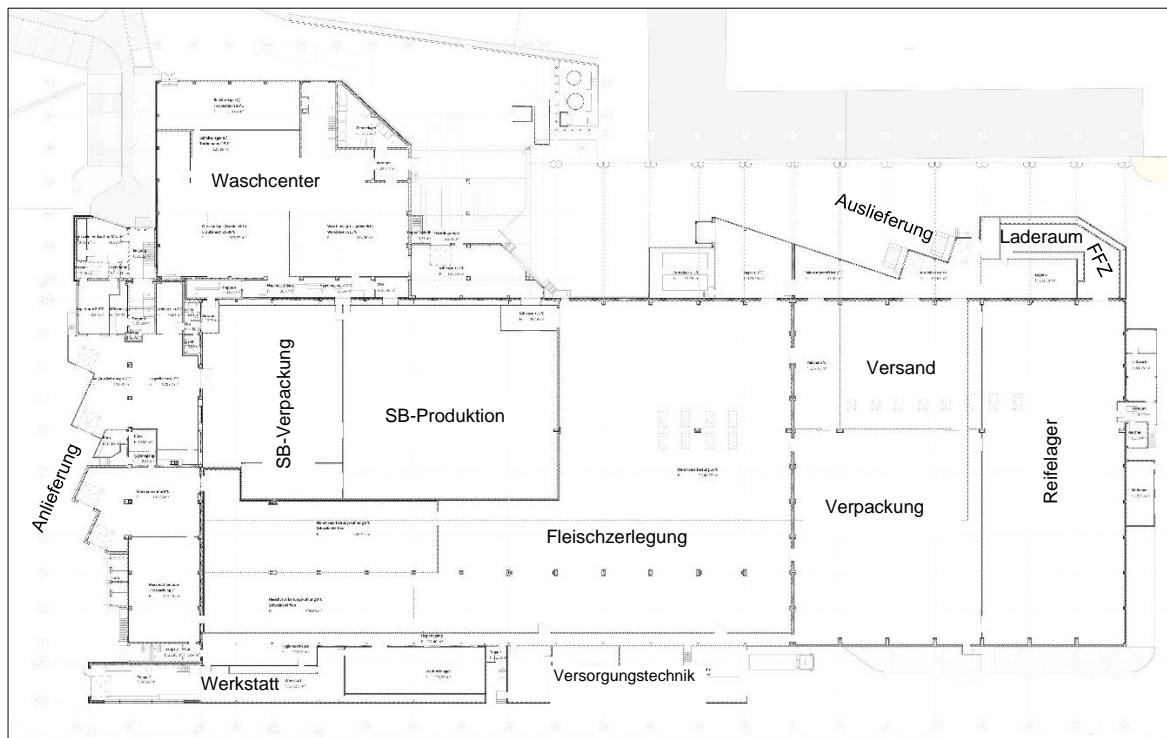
Gebäudegrundriss der BayernFleisch GmbH nach Umbau.
